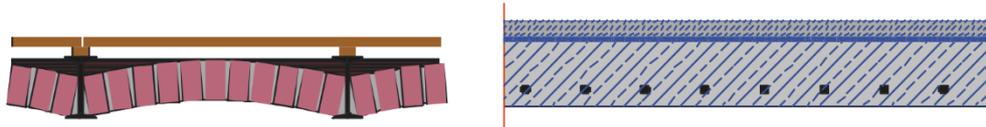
Aufbau Kellerdecke: L: Kappendecke (gemauert) R: Massivdecke (Beton) (Darstellung: IWU)
